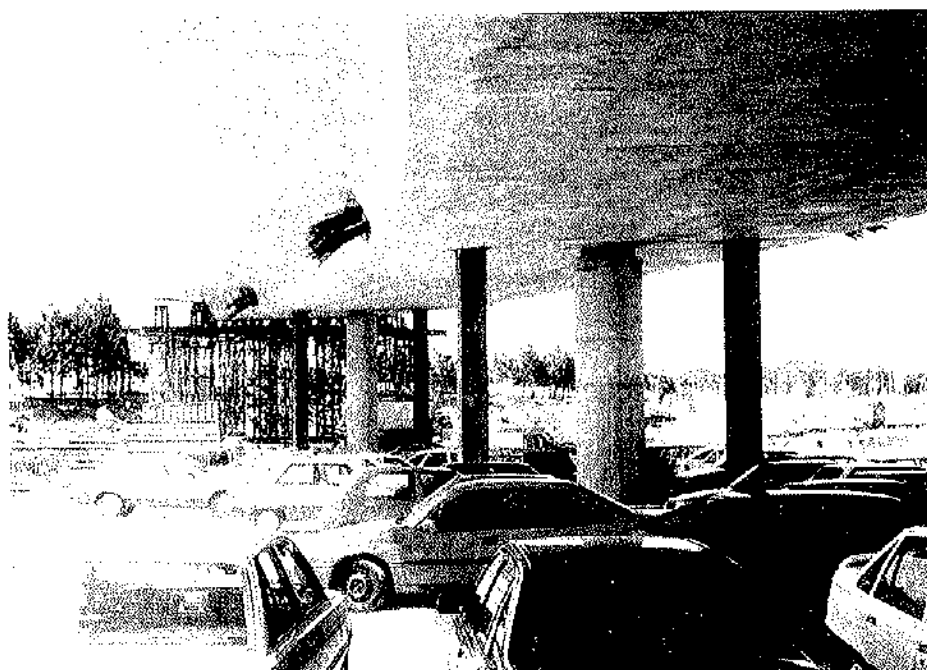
Puntales en pilas 3 y 4 durante la construcción.
